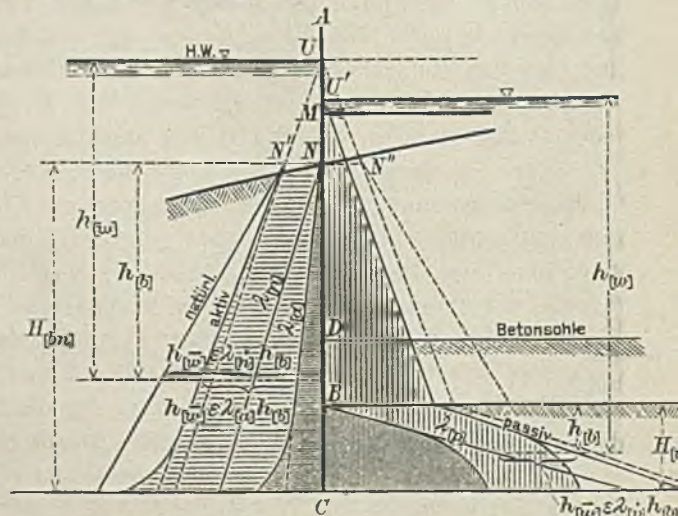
Spundwände für Betongründungen. Verteilung des Erd- und Wasserdruckes bei äußerem Überdruck.
